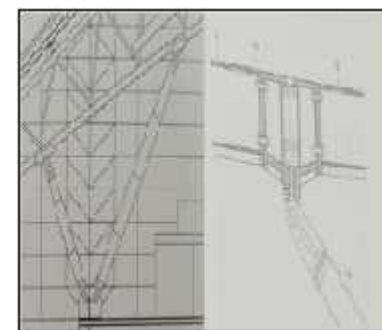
assemblage du poteau arborescent avec la poutre triangulée
